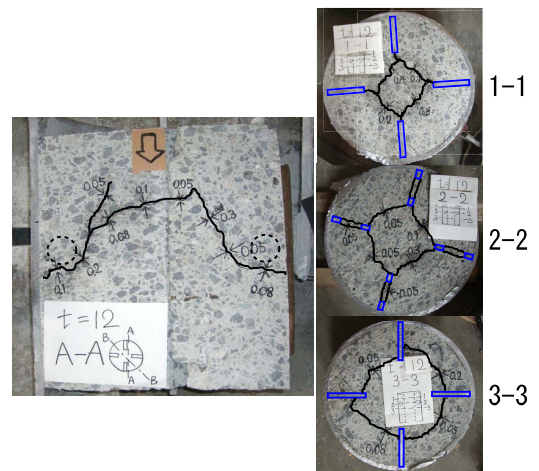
供試体内部のひび割れ (S.C.B100-t12-n4-N-T)
